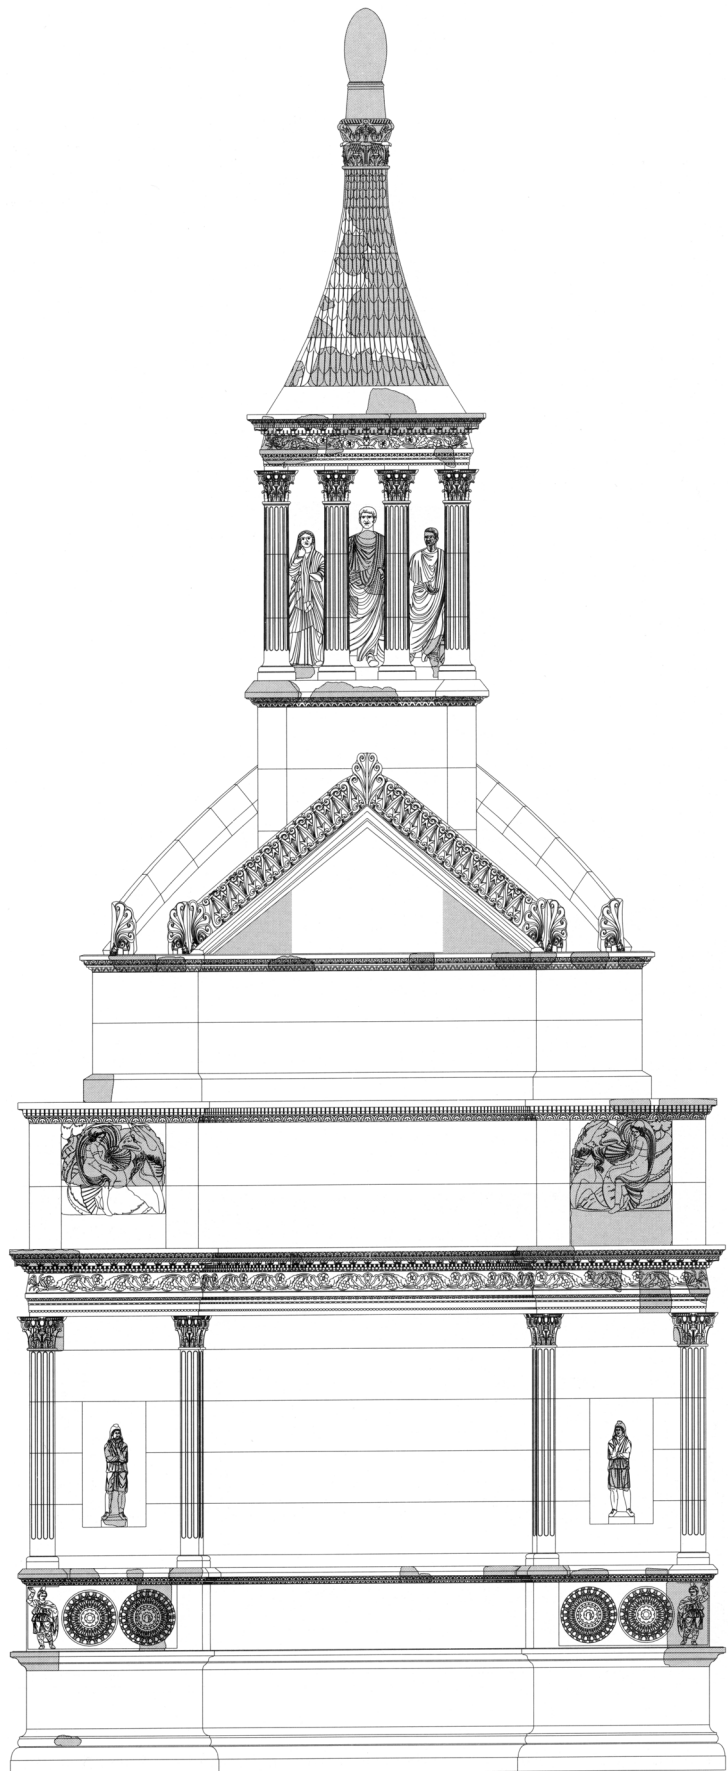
Aventicum/Avenches CH, »En Chaplix«.
